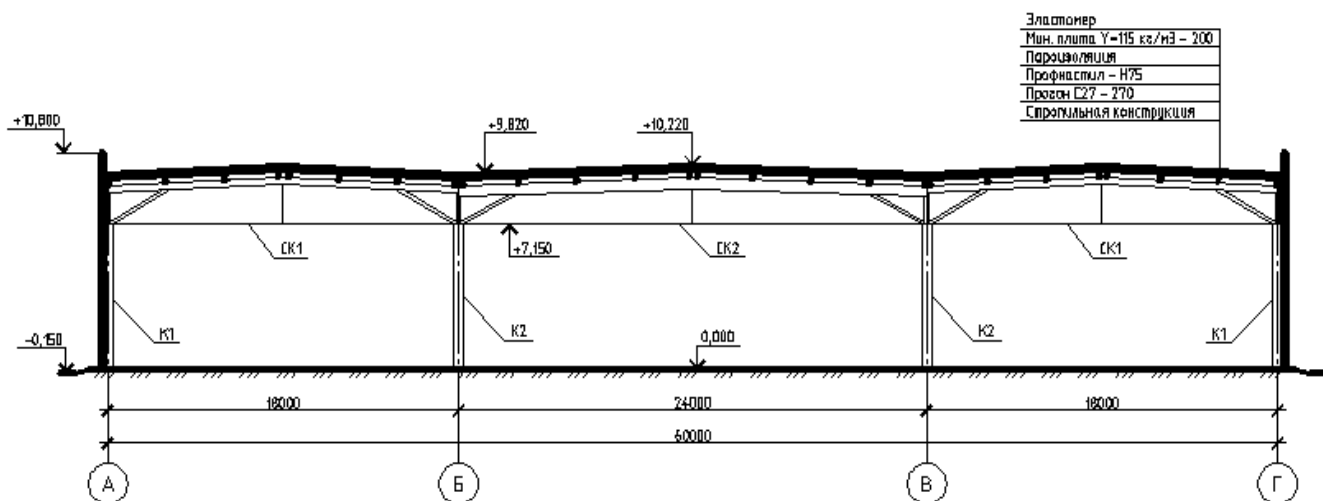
Поперечная рама каркаса здания с балочными конструкциями покрытия переменной жесткости с подкосами и затяжкой
